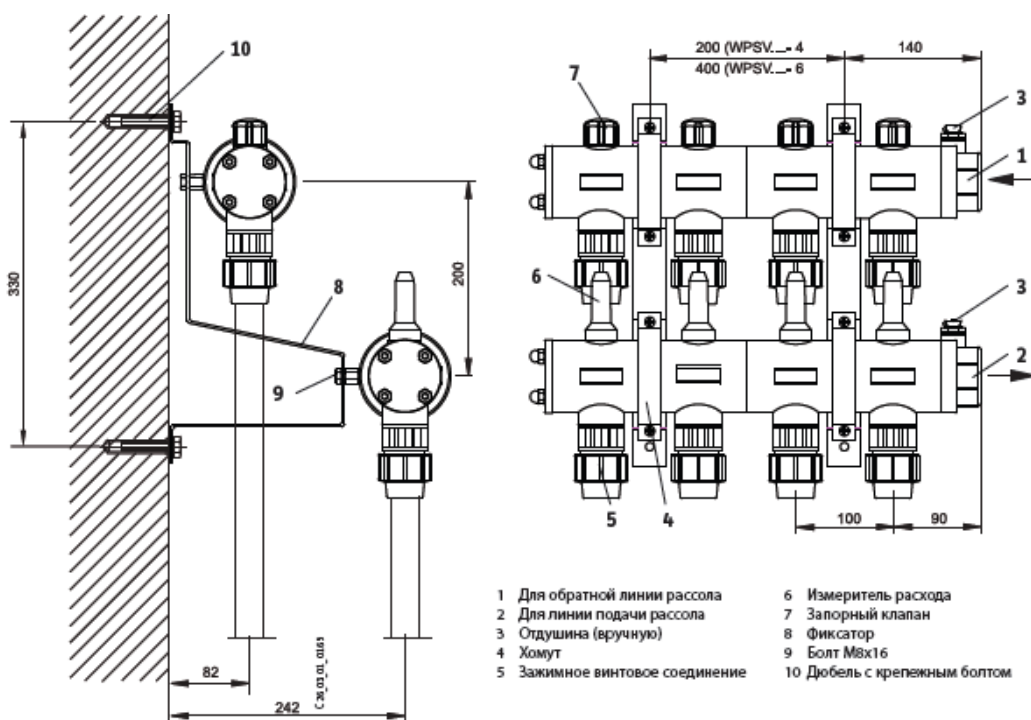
Раздаточный и сборный коллектора рассола
